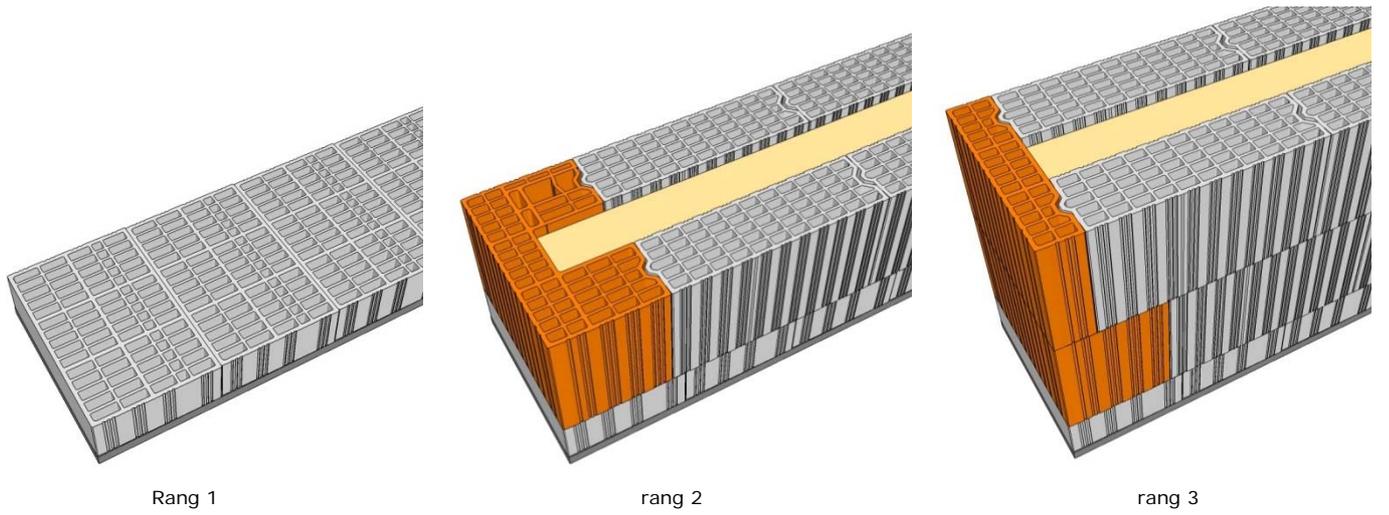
Chaînages horizontaux en about de plancher - section béton élargie
